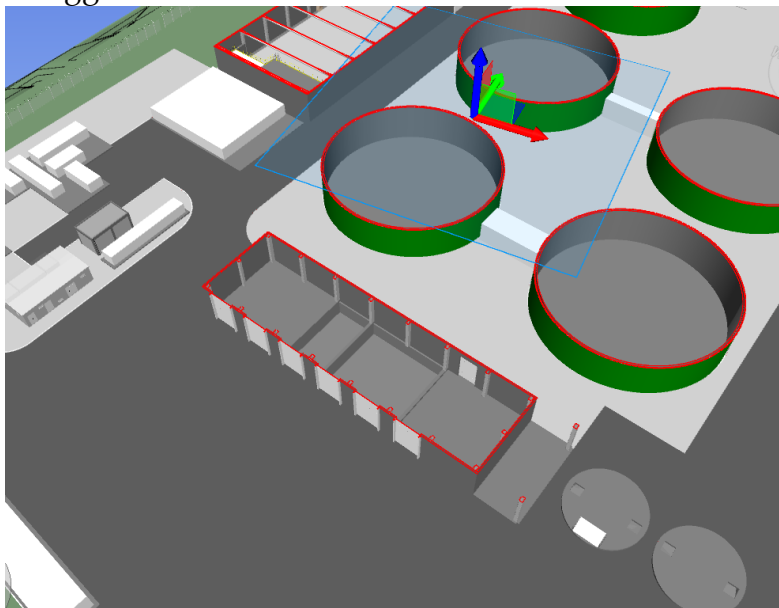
bunker di alimentazione – vista dall'alto senza copertura
